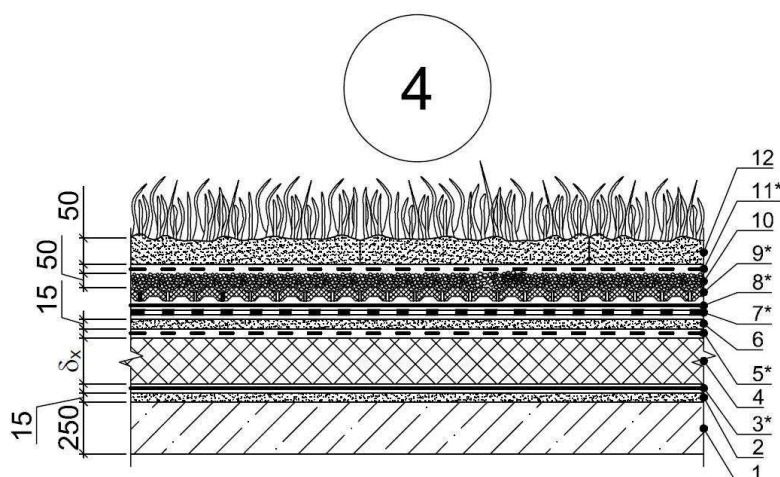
Вариант 4 конструкции покрытия (традиционного)
